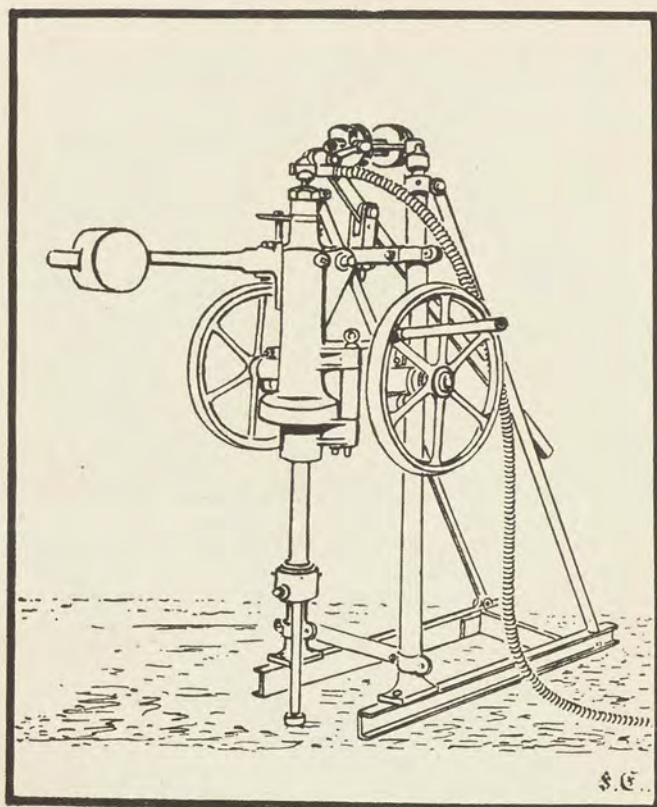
Maschine zum Bohren von Sprenglöchern.
